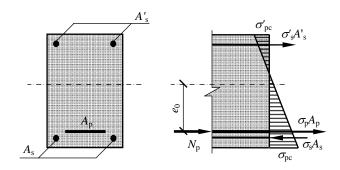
仅受拉区配置预应力钢筋的受弯截面应力
